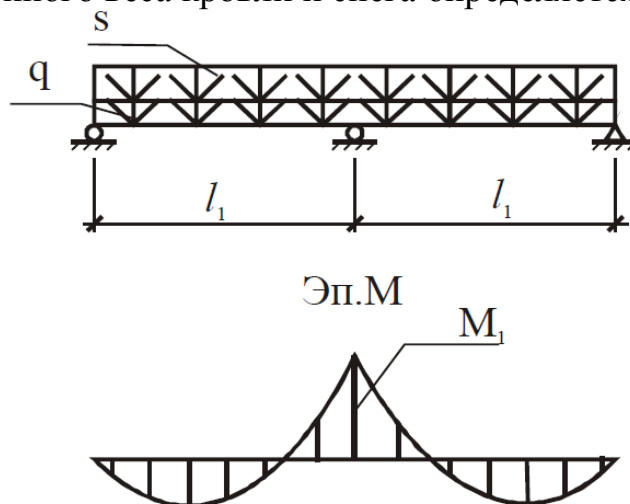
Расчетная схема обрешетки от собственного веса кровли и снега
